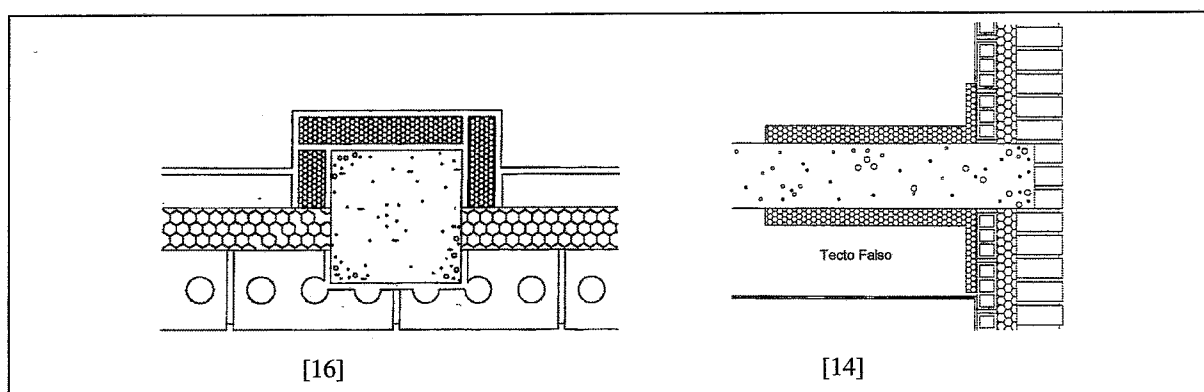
Correcção de ponte térmica pelo interior em zona de pilar e zona corrente de alvenaria e na ligação entre parede e laje de piso intermédio utilizando material isolante
